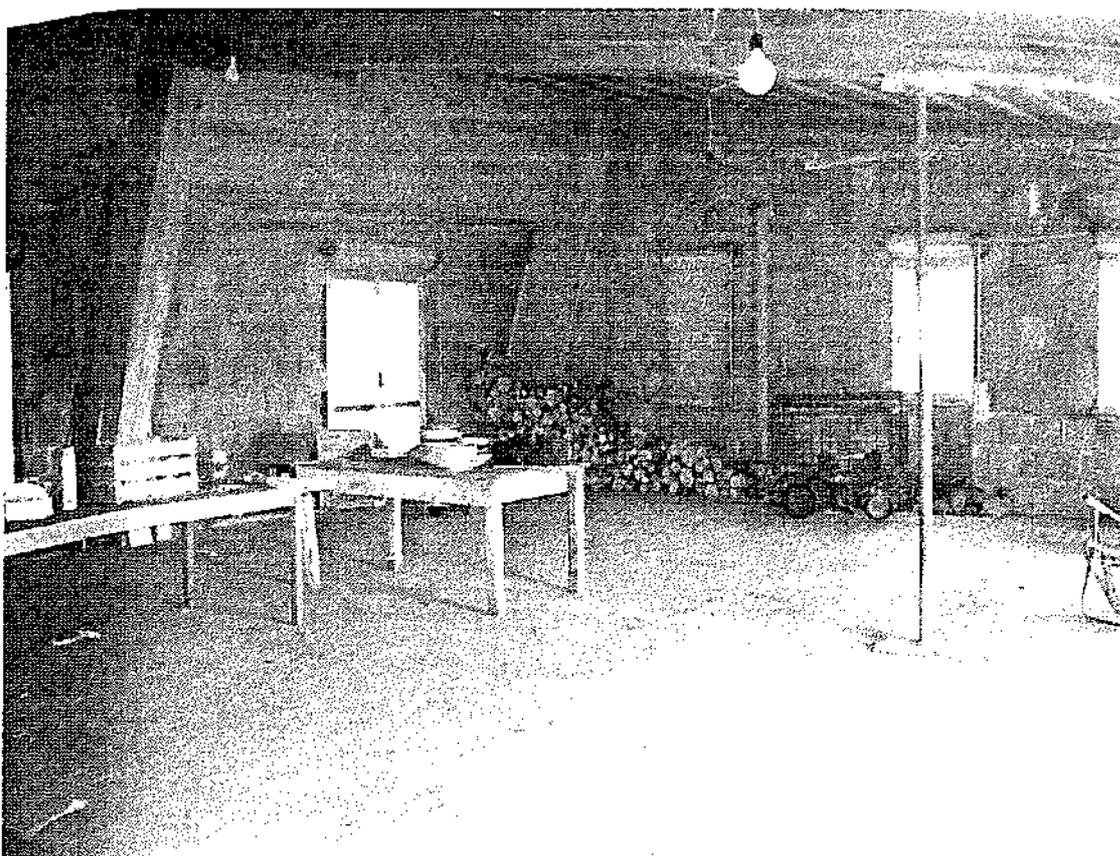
Lotto 6 – Interno della mansarda situata al secondo piano
